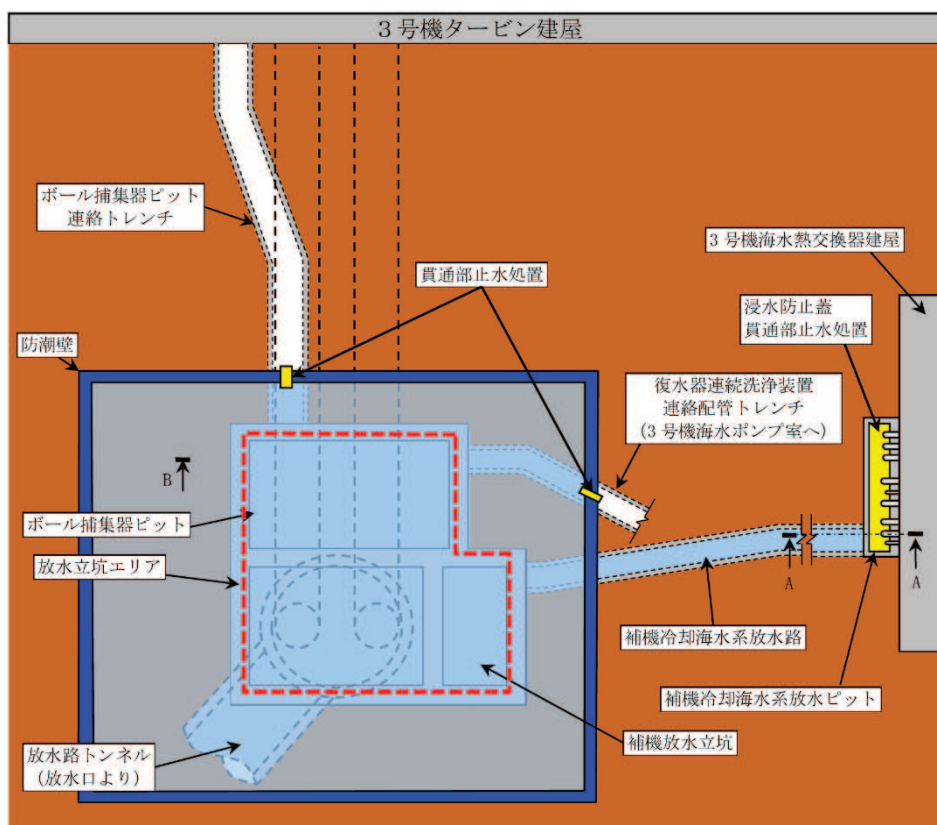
3号機 放水立坑 浸水対策配置図 (平面図)
